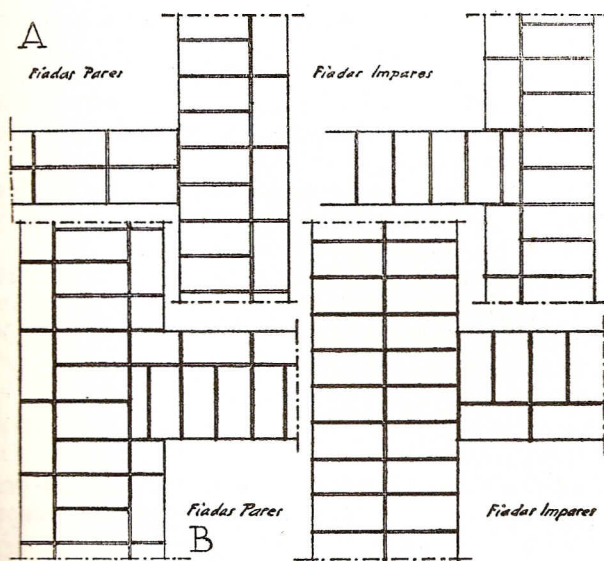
LIGAÇÕES DE PAREDES DE TIJOLO
